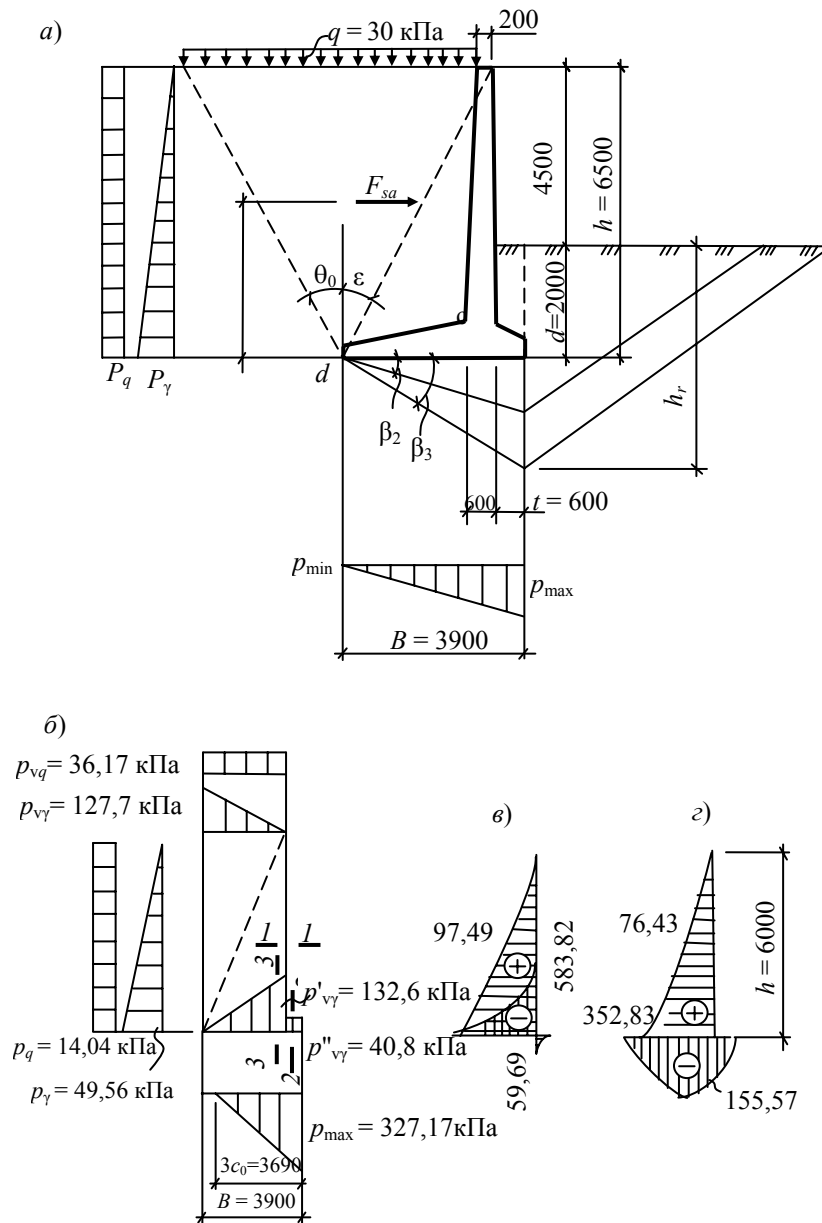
К расчету уголкового подпорной стены: а – конструкция стены; б – схема загрузки; в – изгибающие моменты; г – поперечные силы
